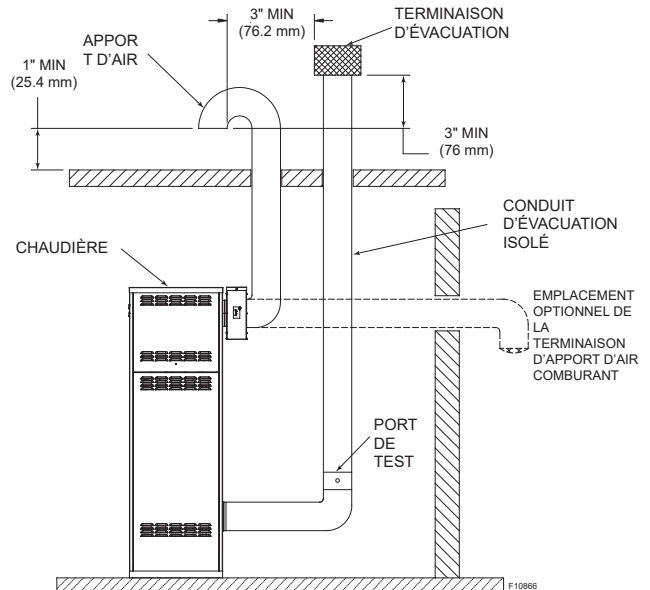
Ventilation verticale avec conduit d'apport d'air comburant
